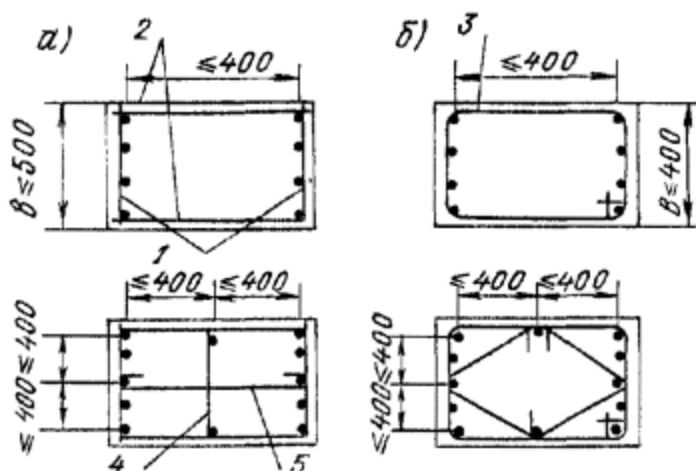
Конструкции сварных и вязаных хомутов во внецентренно сжатых элементах с расчетной сжатой арматурой
